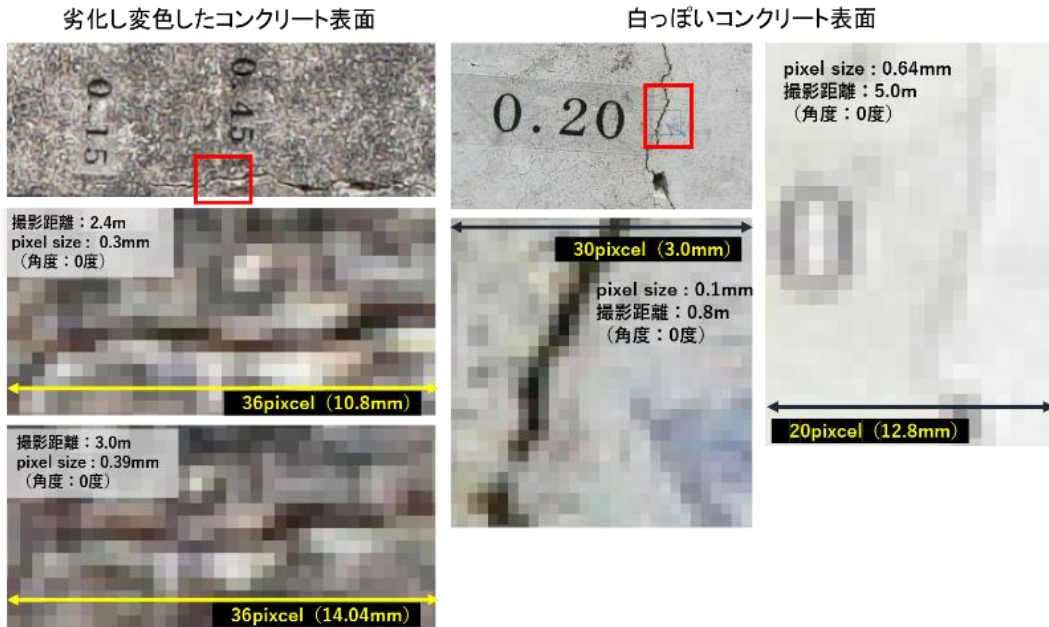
画素レベルでのひび割れの見え方の違い
